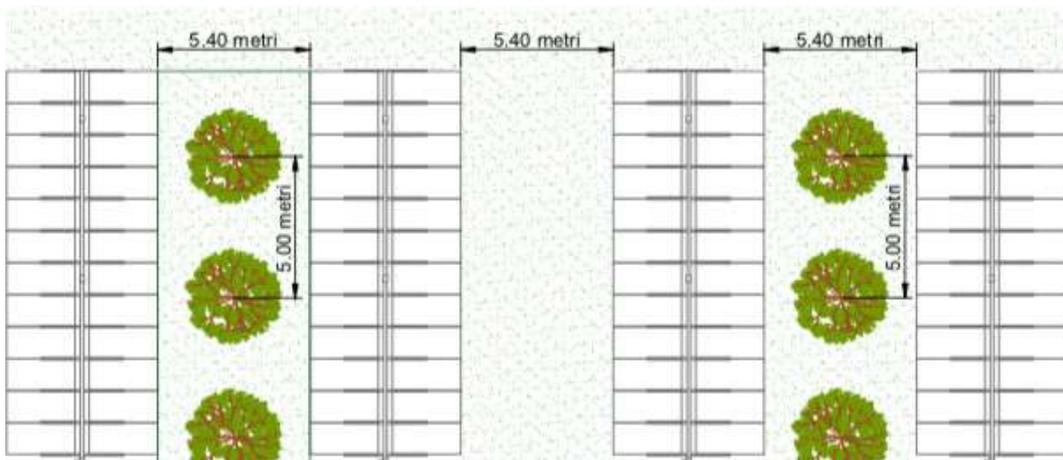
Vista in pianta della disposizione dell'oliveto a file alterne
